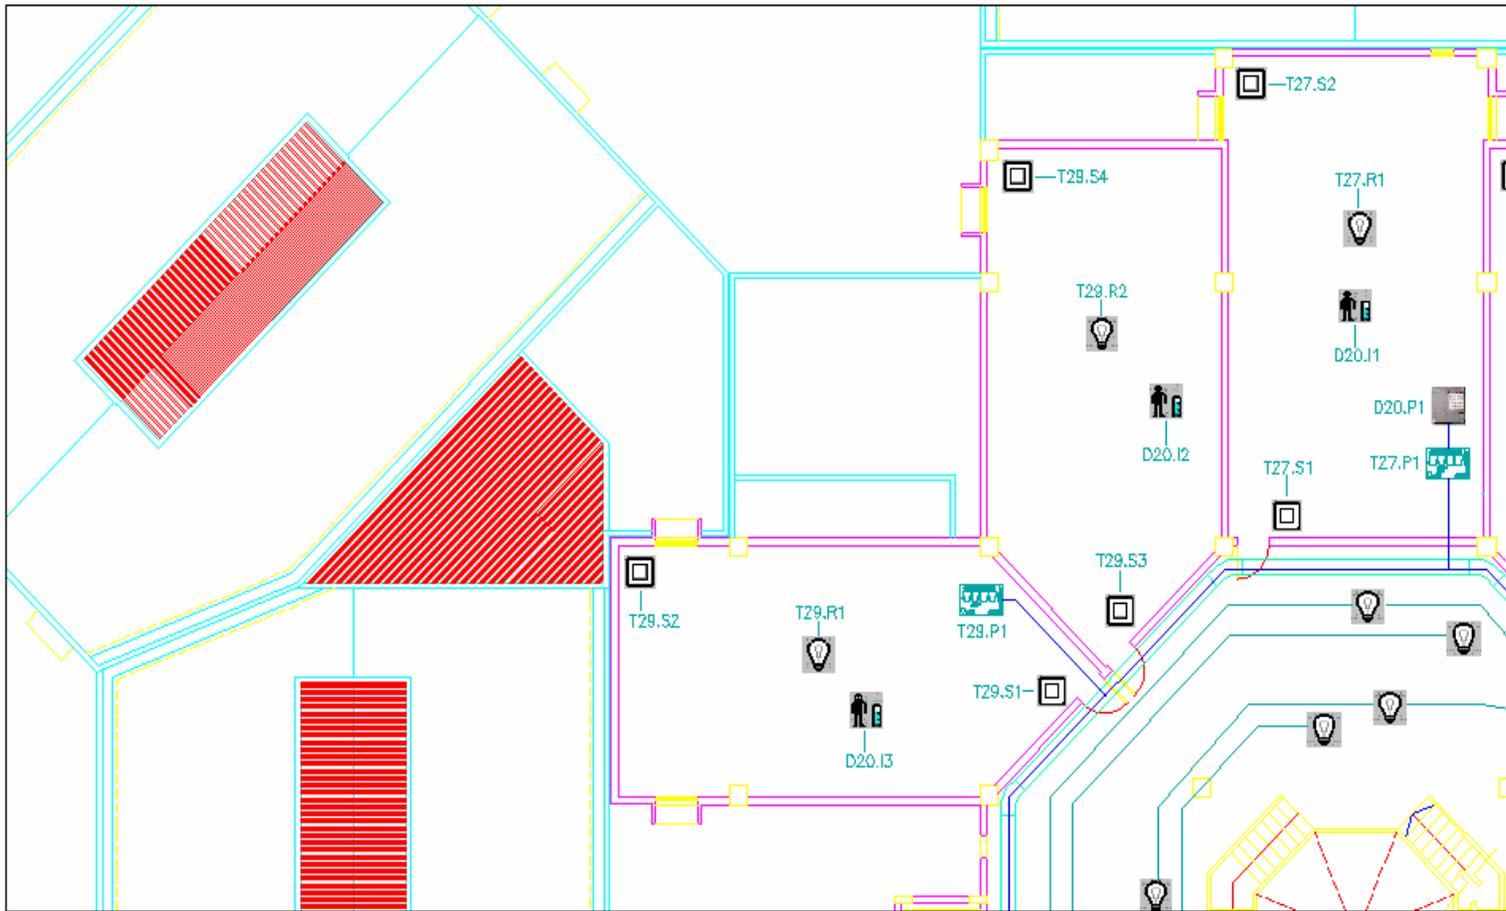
PLANO ILUMINACION PRIMER PISO SECCION 3
